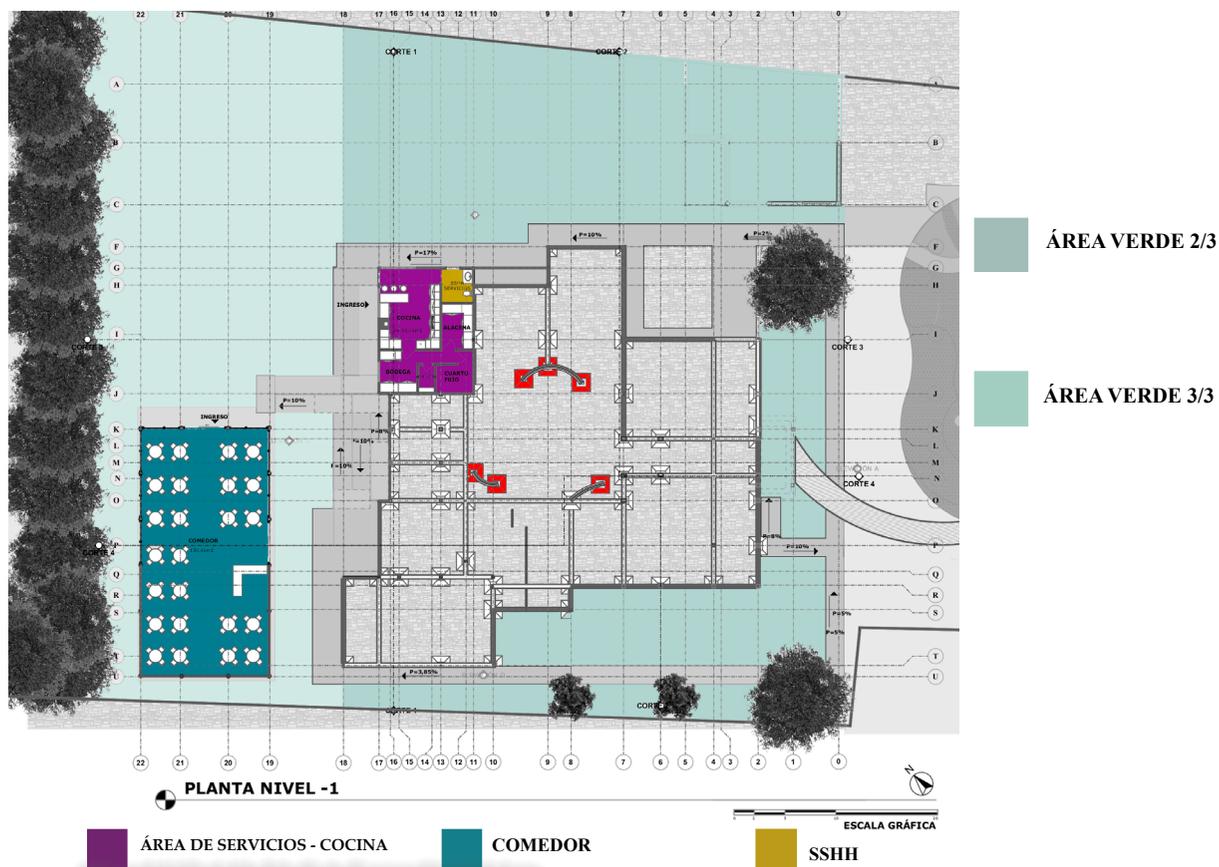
Planta Nivel-1, planta de zonas. Fuente: Autora.
